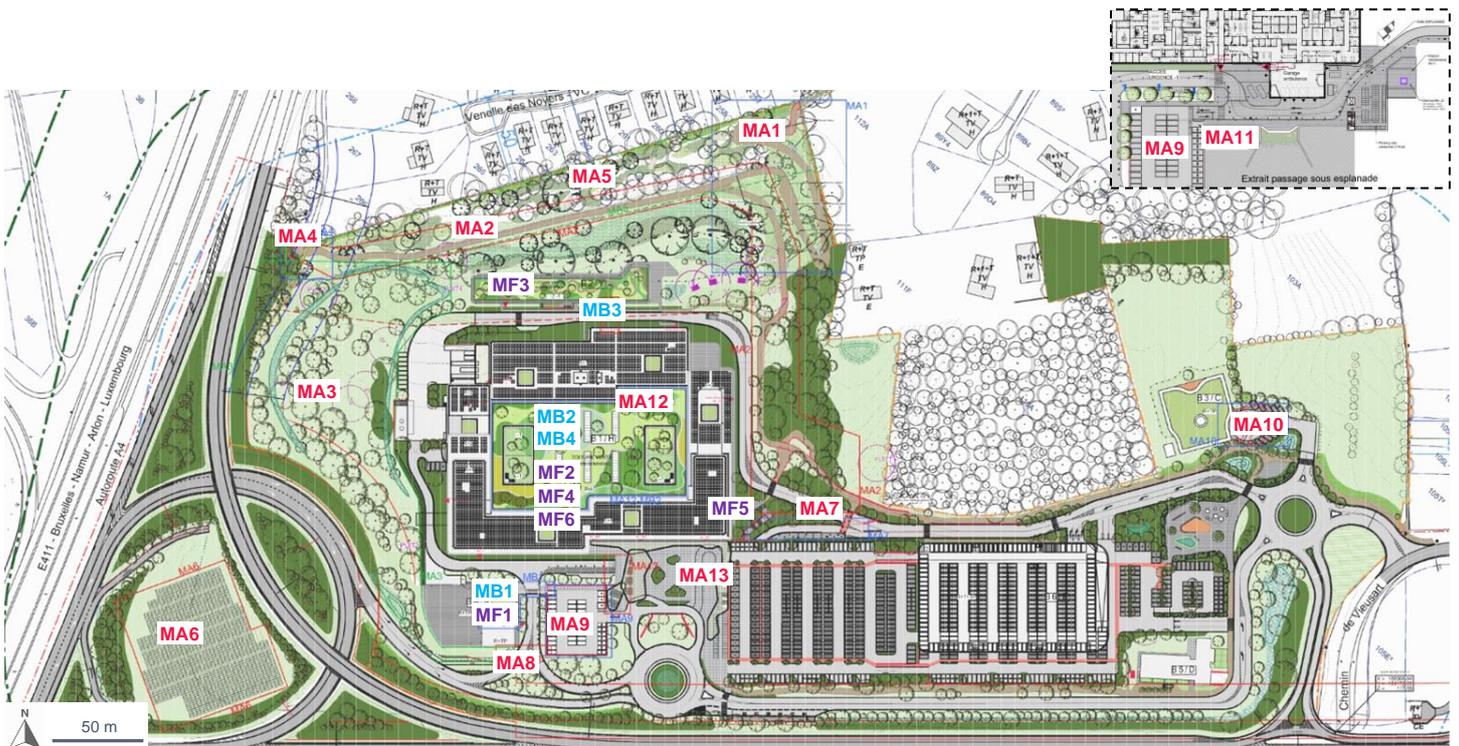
Plan masse – Modifications apportées au projet (source : ASSAR)
